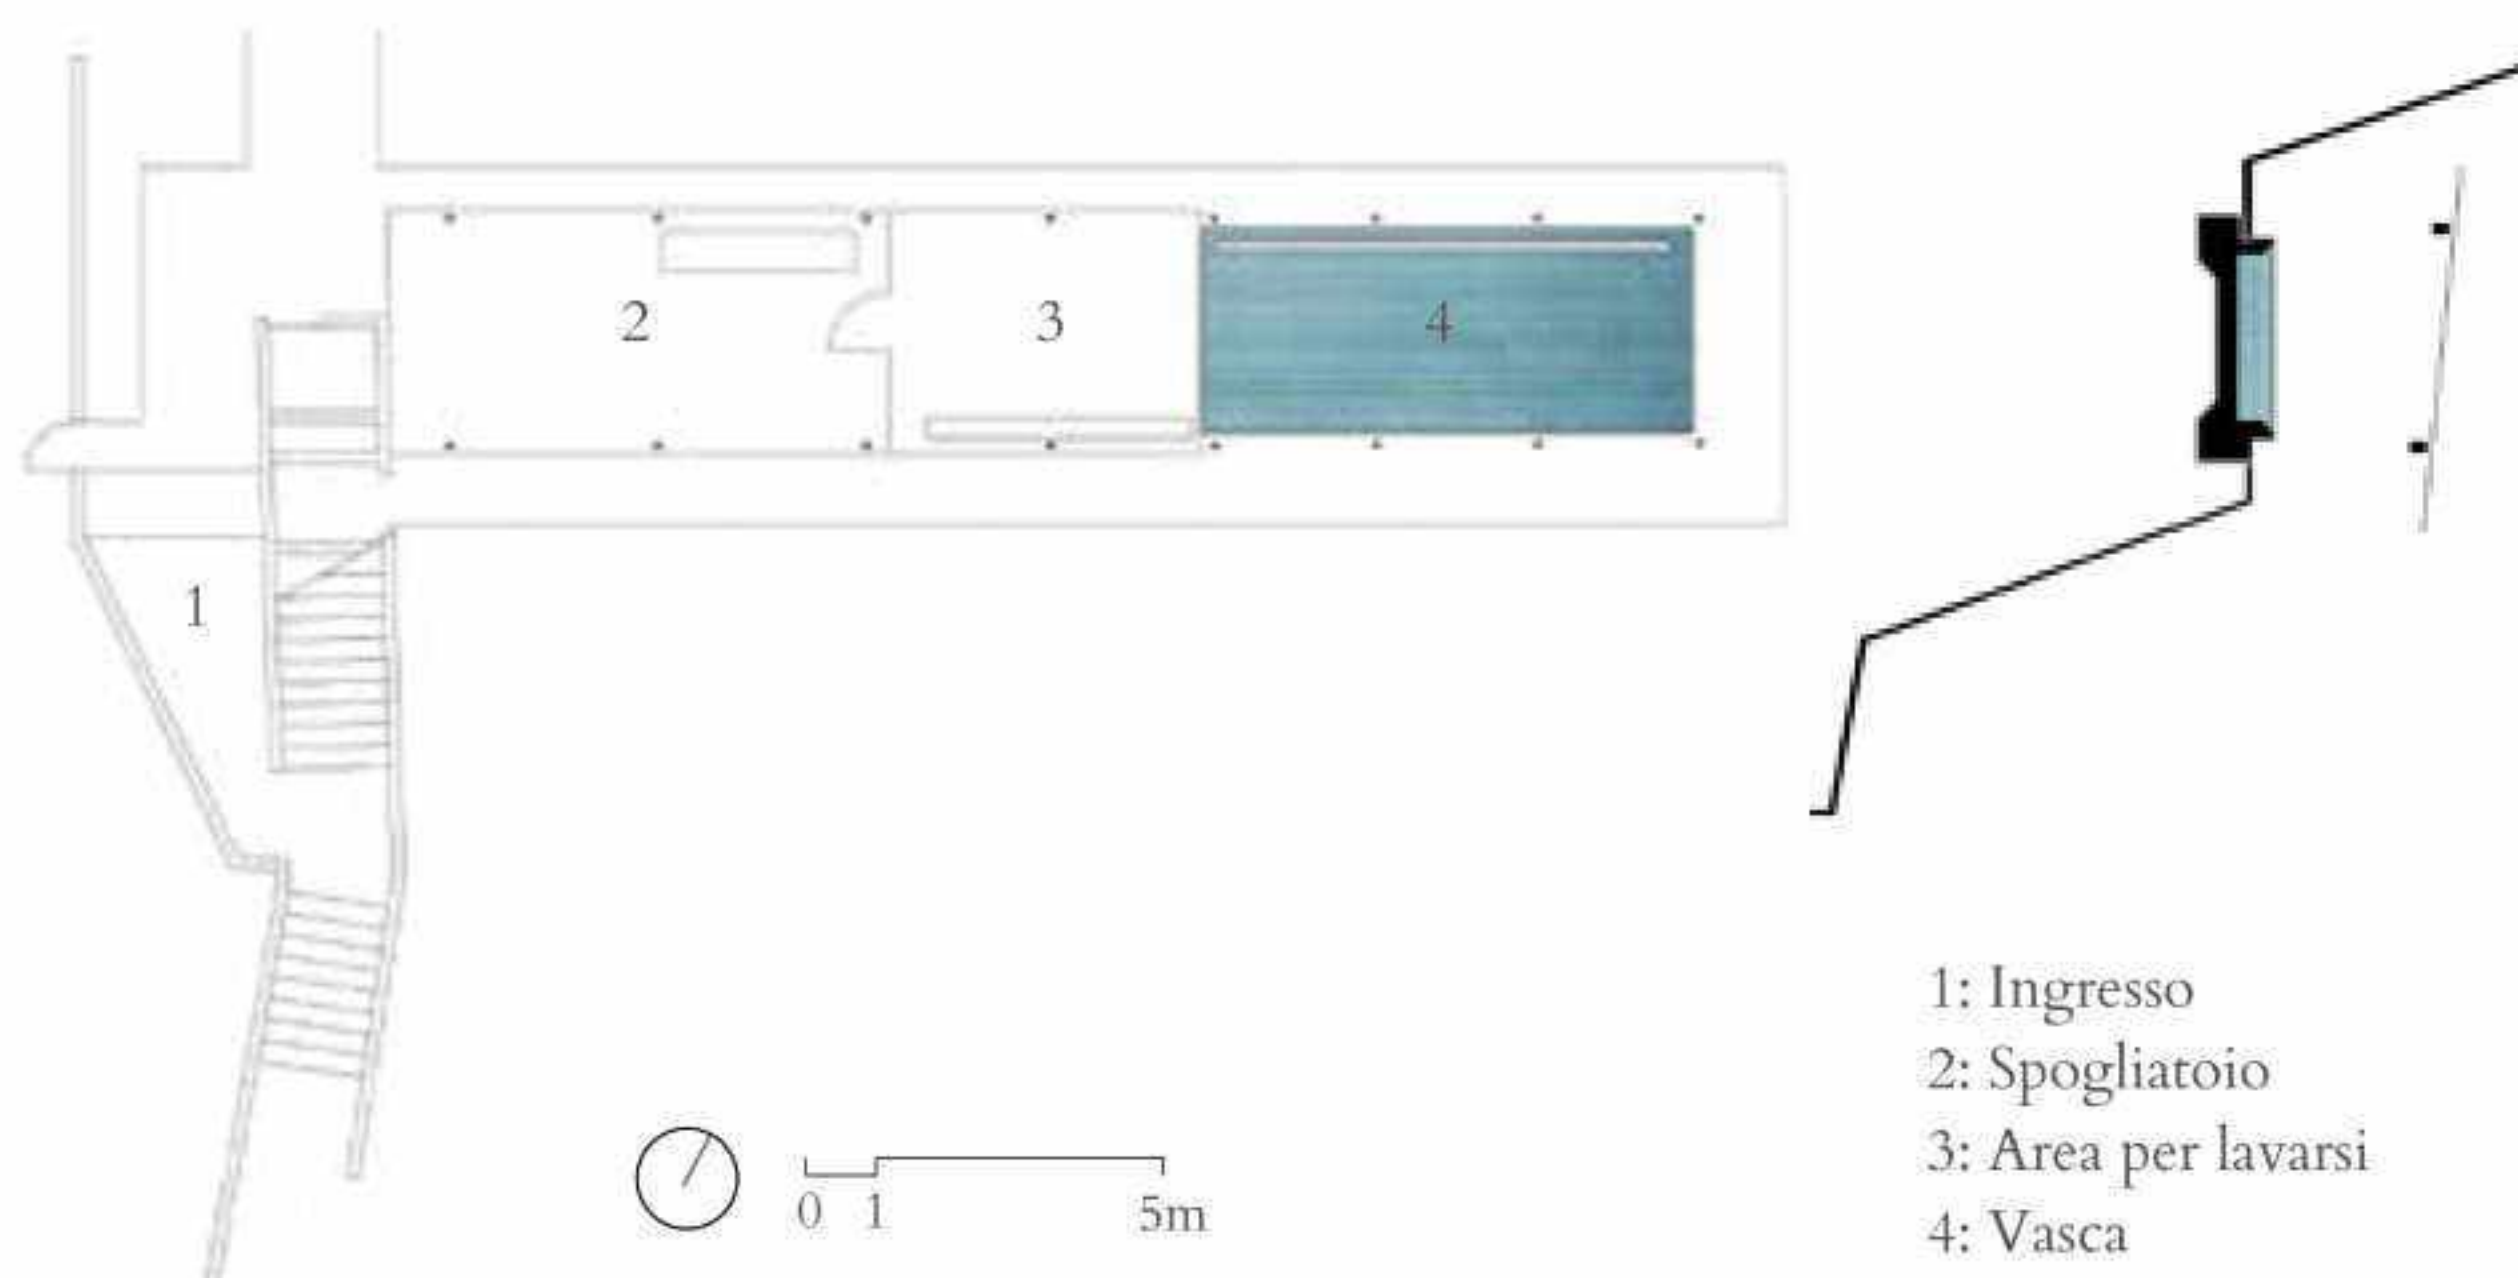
Onsen Horai*, pianta piano terra e sezione trasversale.
